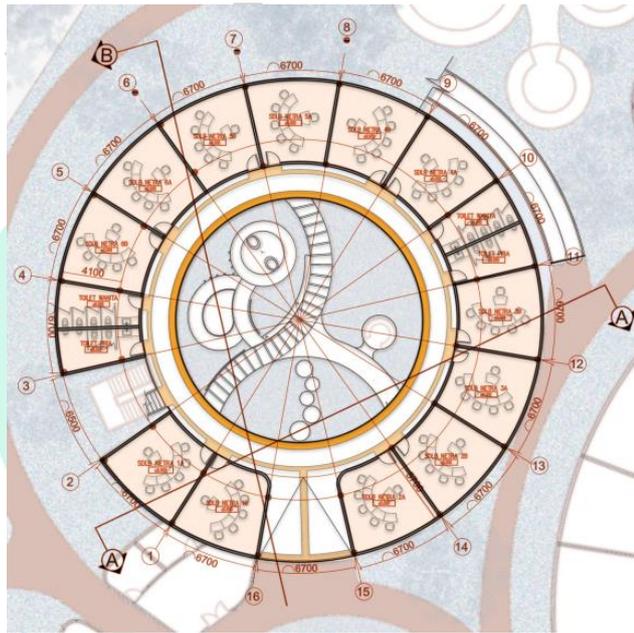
4 Denah Lt. 2 Bangunan Utama
